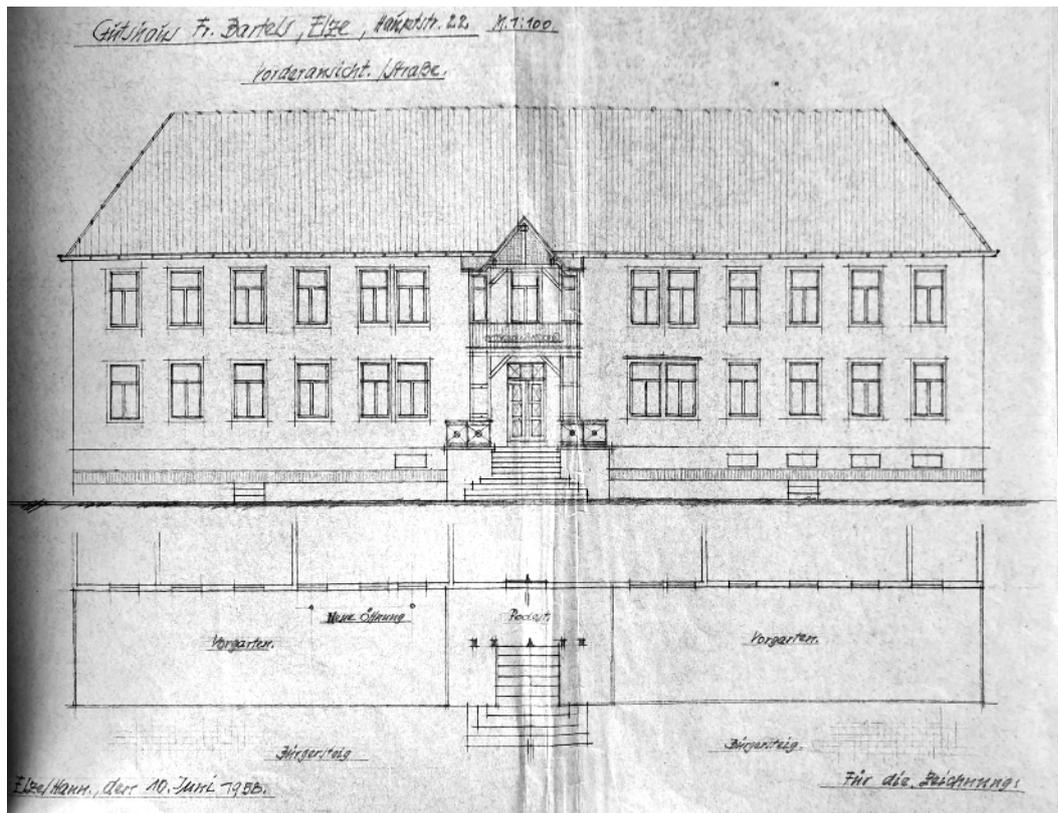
Fassadenzeichnung und -grundriss im Bestand vor Einbau eines Panoramafensters im Erdgeschoss im Jahr 1958. Der Loggienvorbau über dem Eingang ist noch vorhanden.
